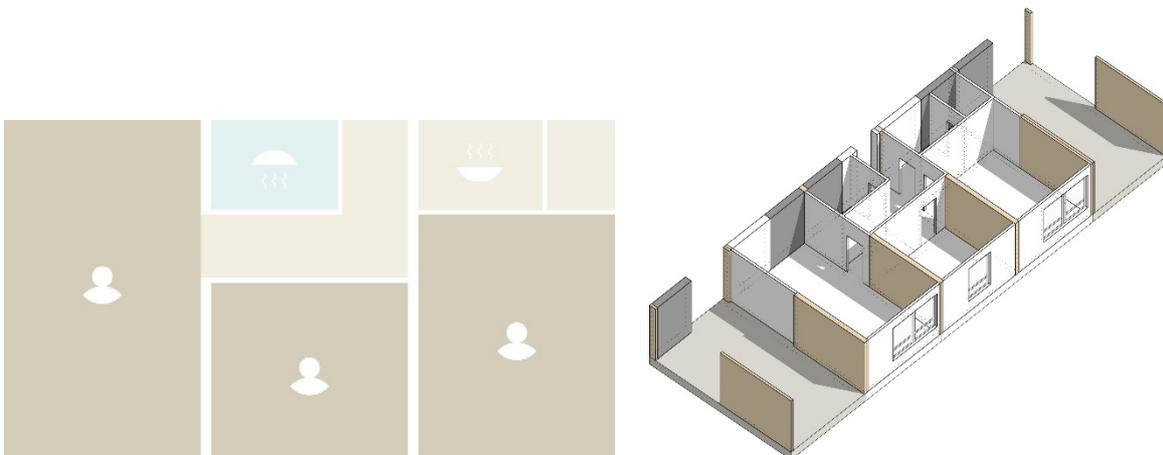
Schema Grundriss 3-Zimmer inkl. Wohnküche (Architekt Schweizer)
